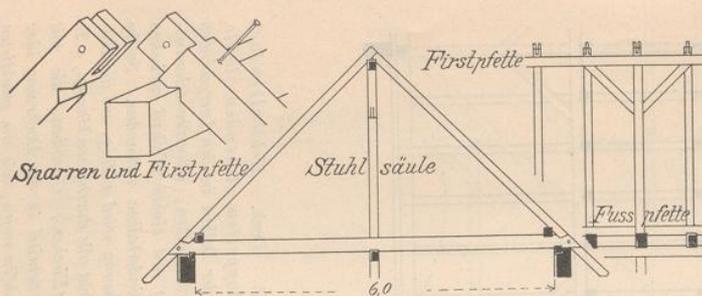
Dach. Pfettendach mit einfachem stehenden Stuhle.
